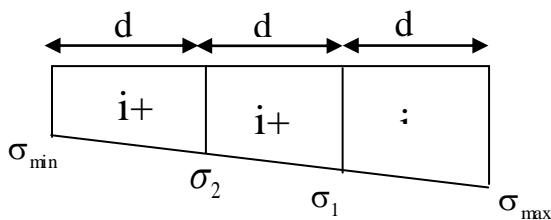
diagramme d'une section entièrement tendue.
